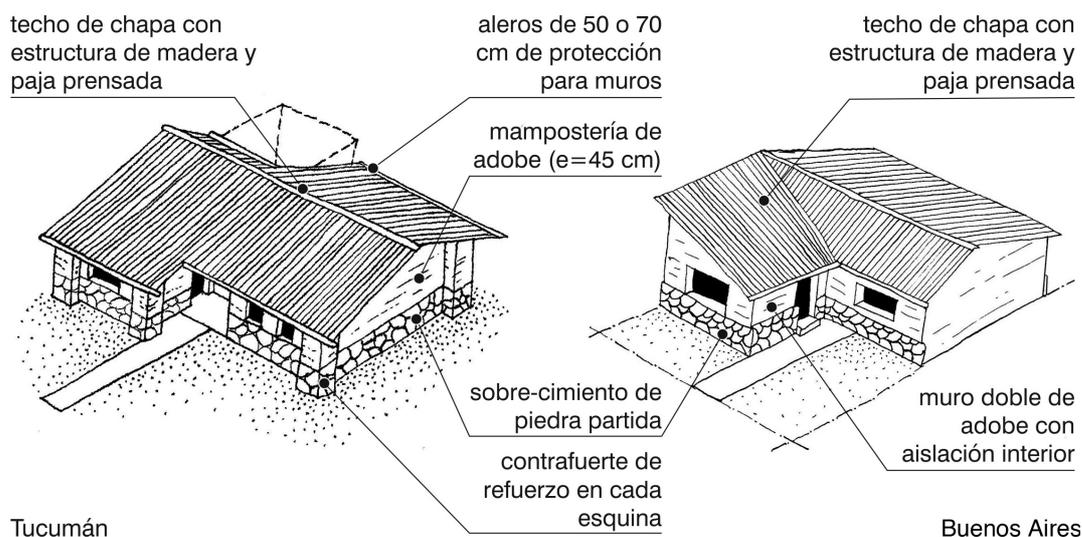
Viviendas adaptadas a la construcción con tierra cruda.
